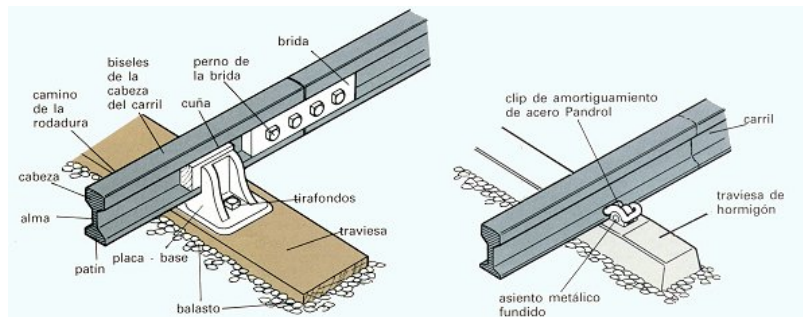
3: Carril de cabeza gruesa mostrando la brida de cuatro pernos (izquierda), y el clip sujeta el carril a la traviesa de hormigón (derecha)
